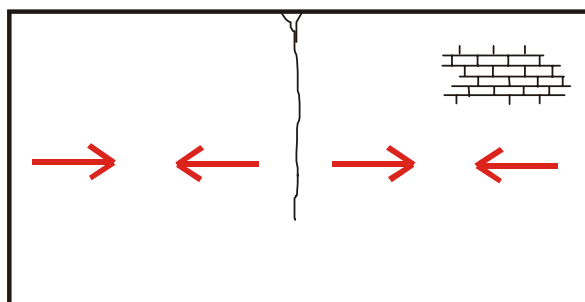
fissura vertical em parede por retração da alvenaria. Caso típico de muro com borda livre construído em blocos de concreto (DUARTE, 1998)
